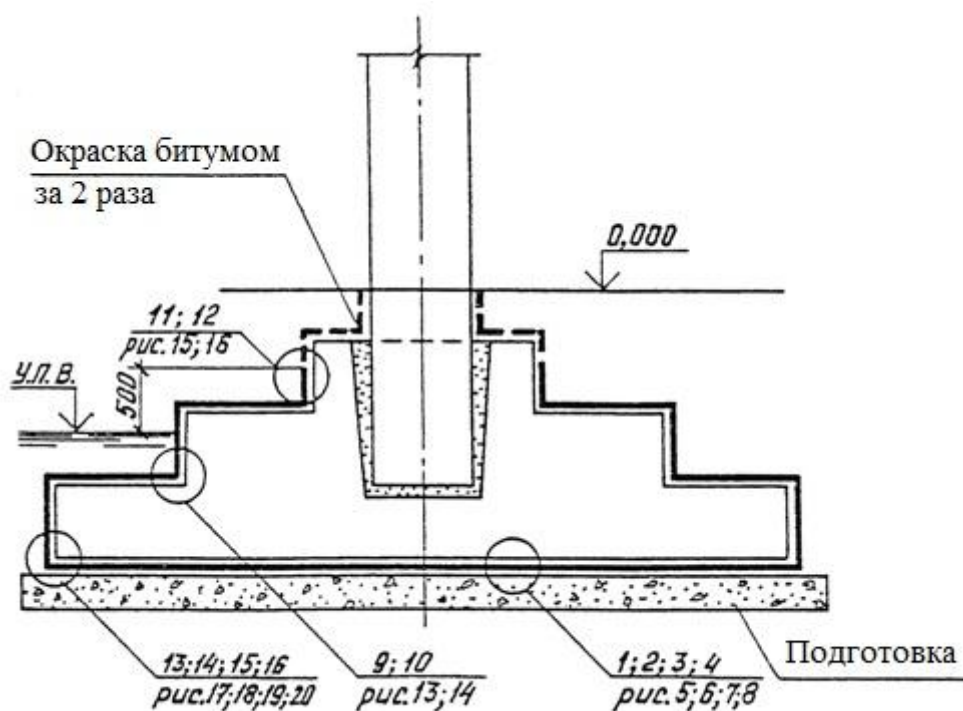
Гидроизоляция фундамента под колонну
